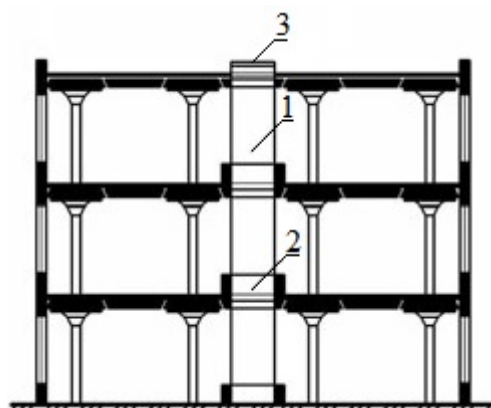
Характерный поперечный разрез по многоэтажному промзданию со световыми колодцами: 1 - Остекление колодца; 2 -Проем в перекрытии; 3 - Зенитный фонарь.
